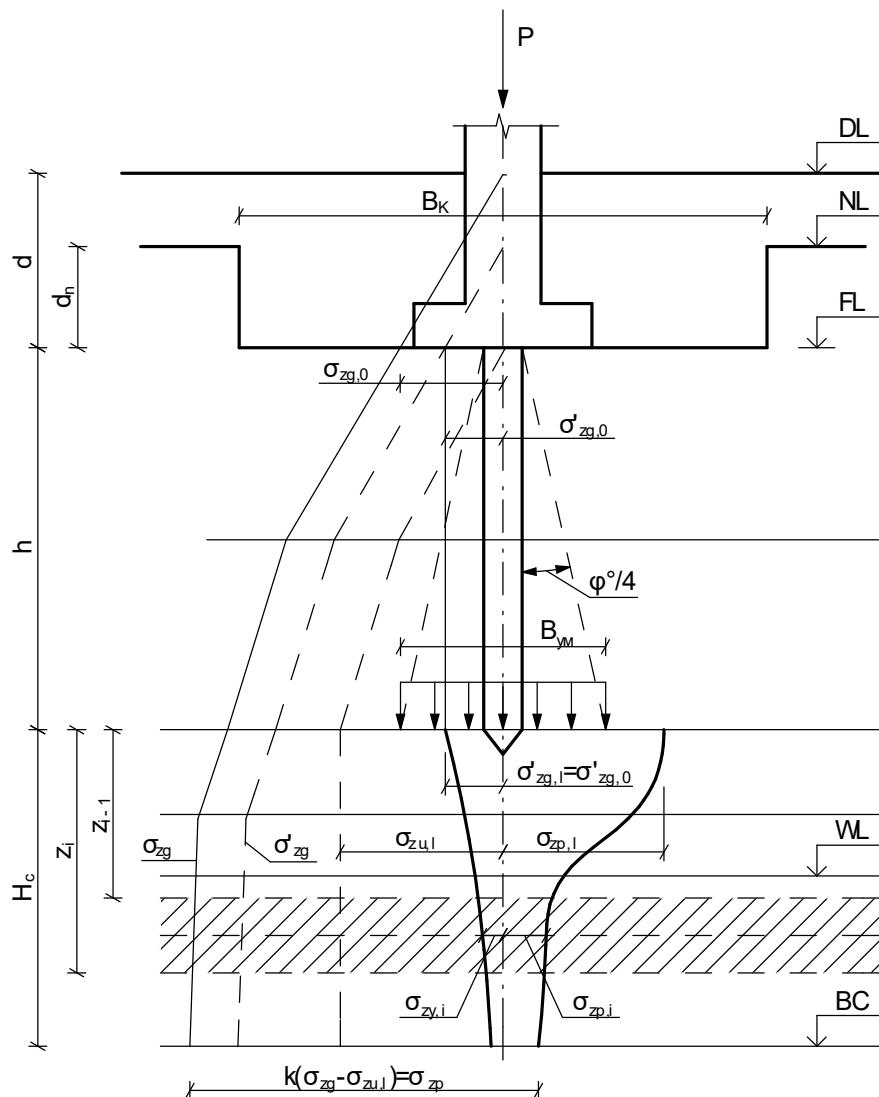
Схема розрахунку пального фундаменту за деформаціями основ
